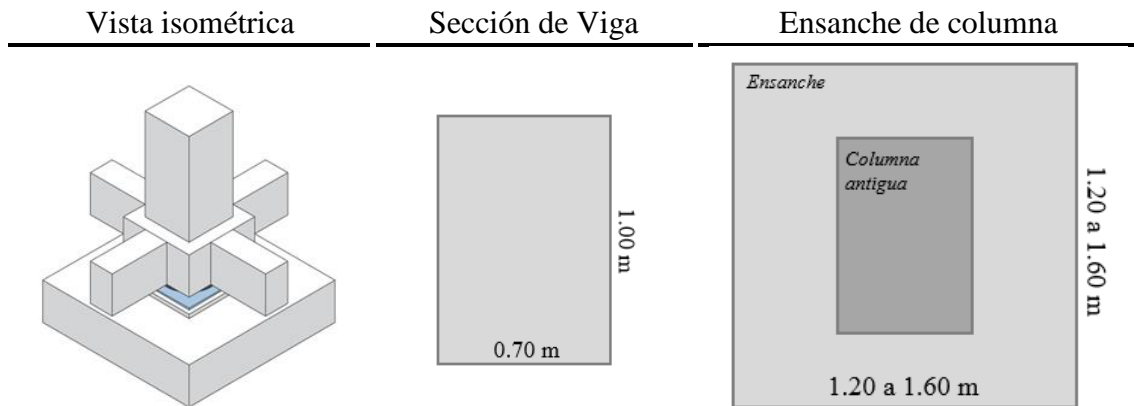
Esquema de las secciones de vigas y columnas de la interfaz de aislamiento
